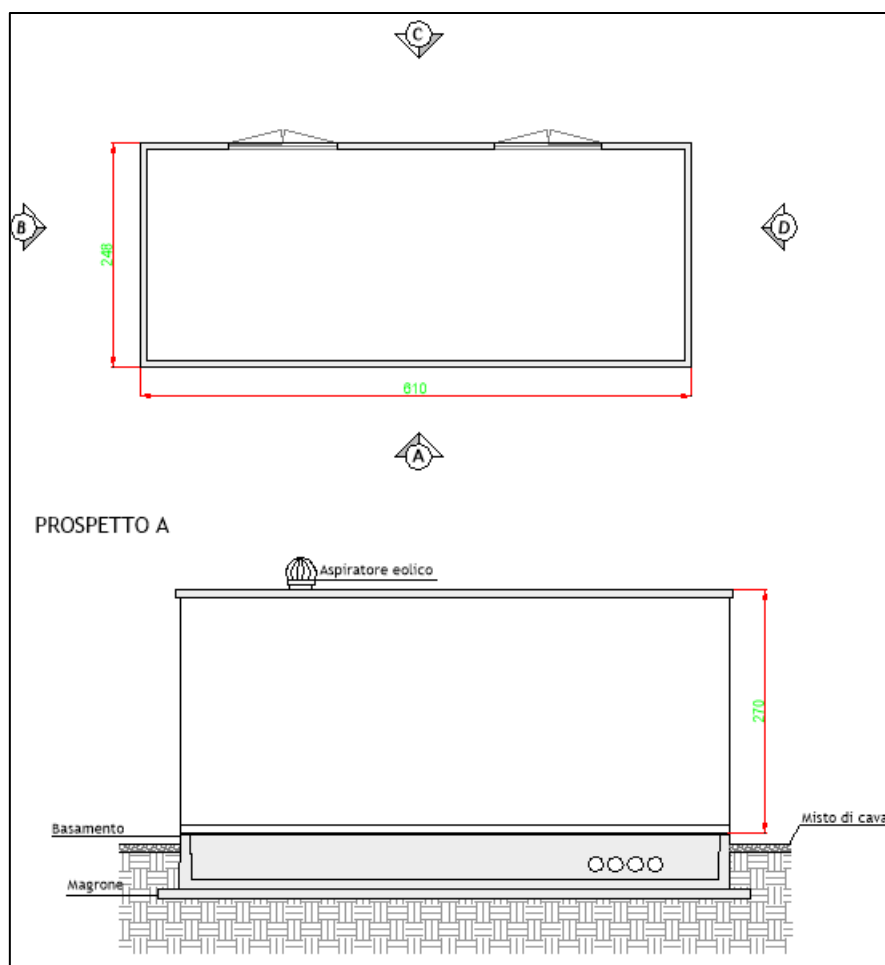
Planimetria e prospetto della Cabina di Trasformazione
